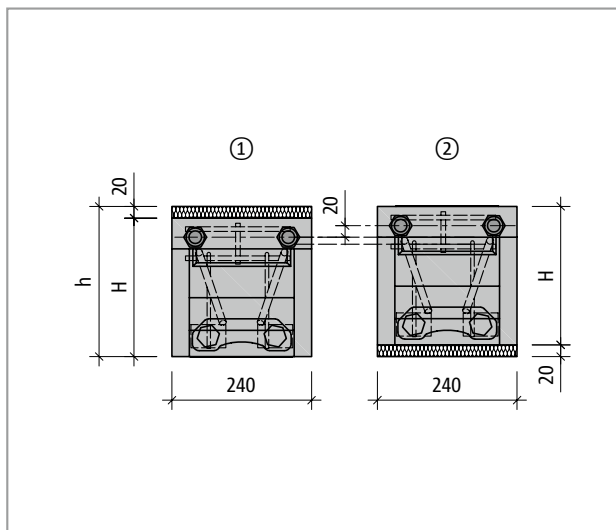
Schöck Isokorb® T type K-IQ : disposition avec décalage en hauteur
